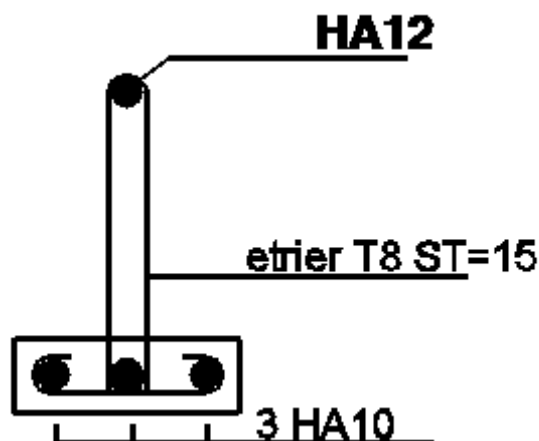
Schéma de ferrailage de la poutrelle en travée et en appuis
